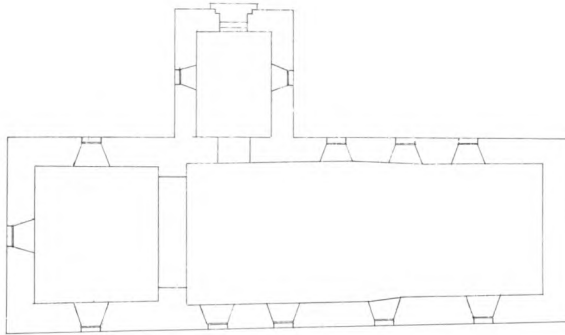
Grundplan 1:300, målt forud for kirkens nedrivning 1884. – *Grundriss der Kirche vor dem Abreissen.
